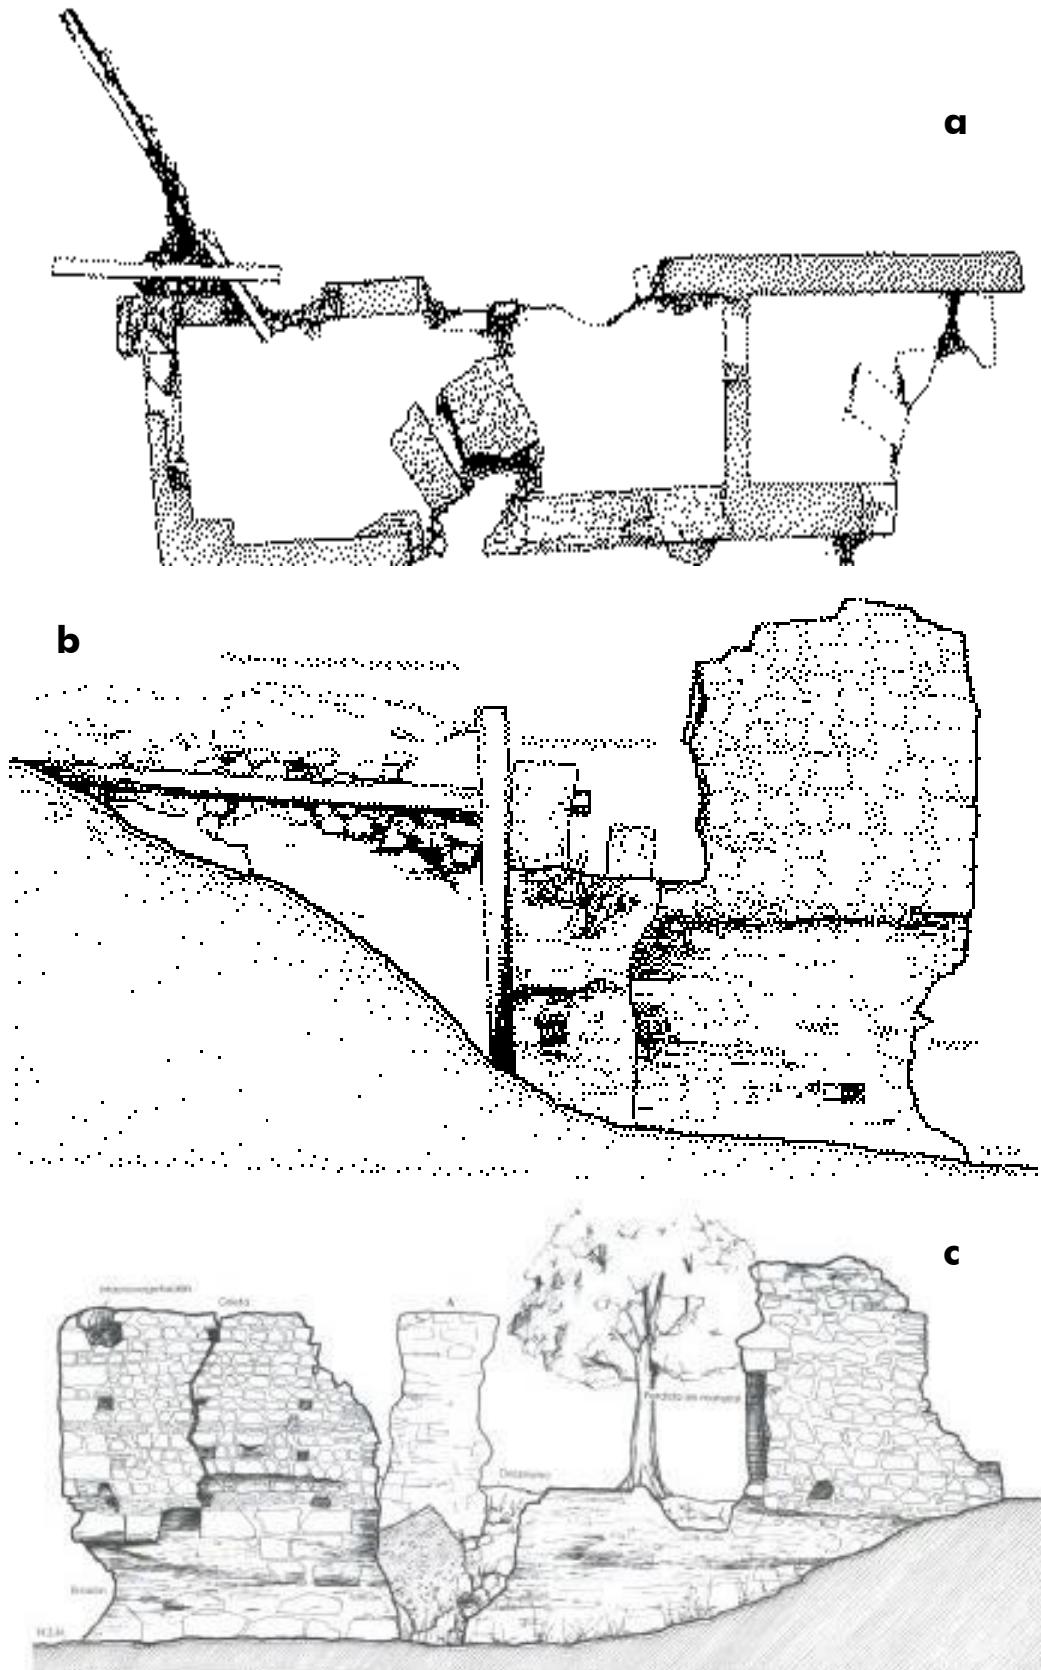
a, planta arquitectónica; b, elevación lateral (se ve el relleno); c, elevación posterior de las Casas Reales (PPV).
